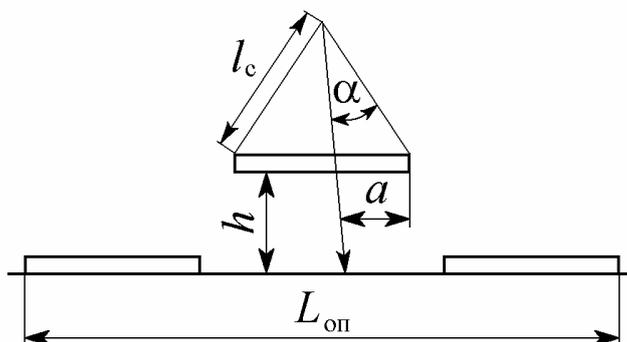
Схема к определению границ опасной зоны при работе грузоподъемной машины
